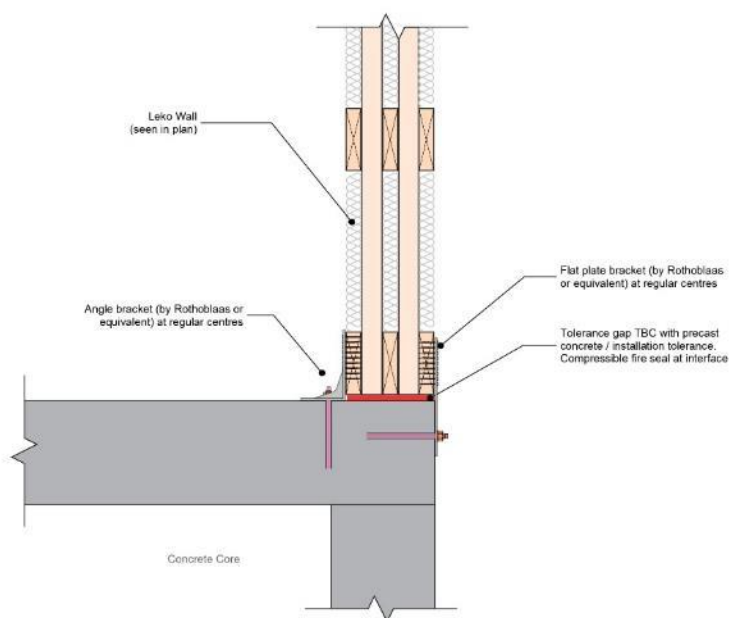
Exemple de Connexion entre mur LEKO LABS et noyau béton
